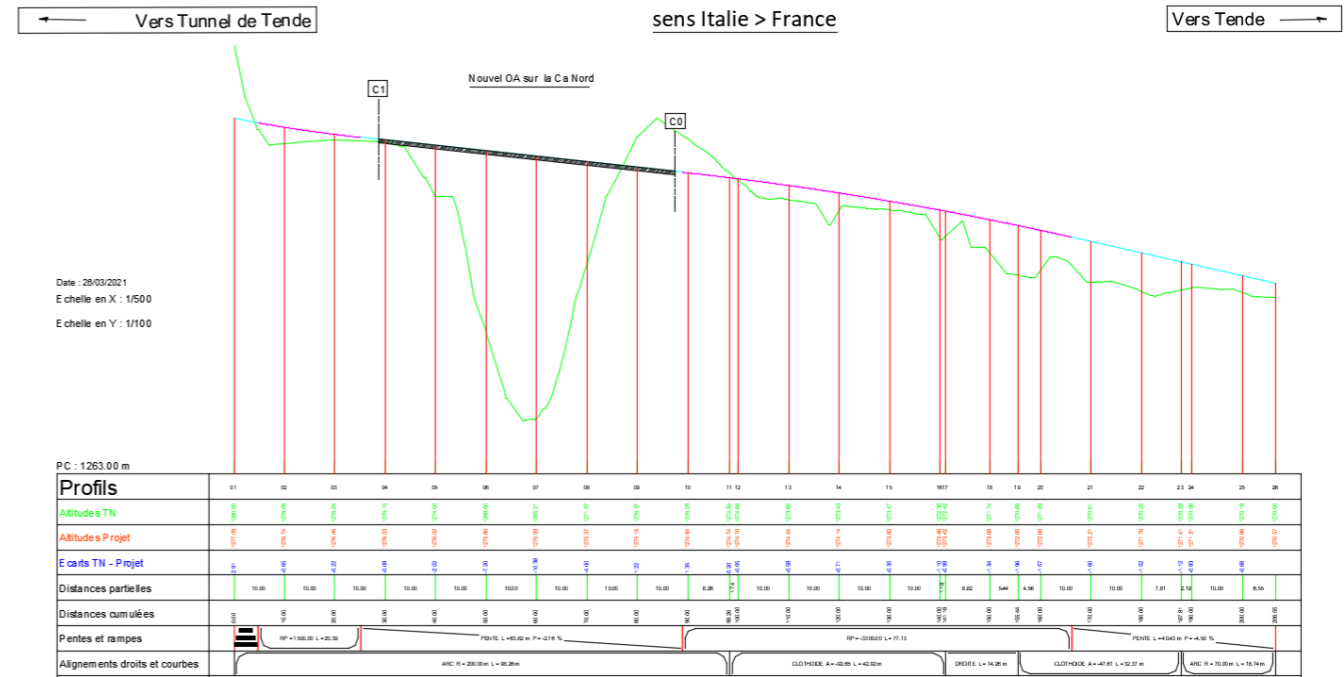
Due strutture - Struttura Nord - Profilo longitudinale
